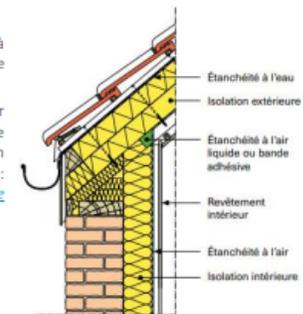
Jonction isolant façade et toiture (image de Buildwise)
